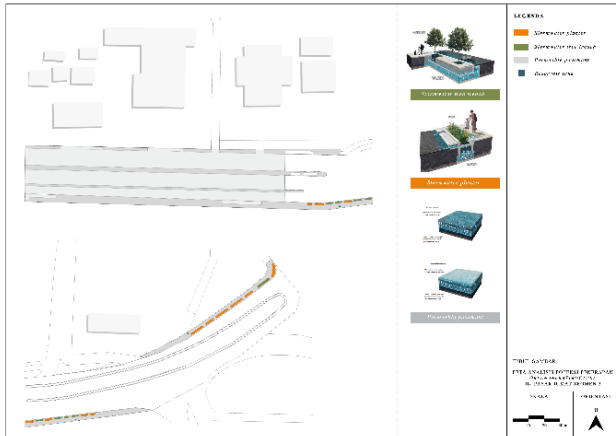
(a) *Stormwater tree trench*, (b) *Stormwater planter*, (c) *Green gutter*, (d) *Permeable pavement
